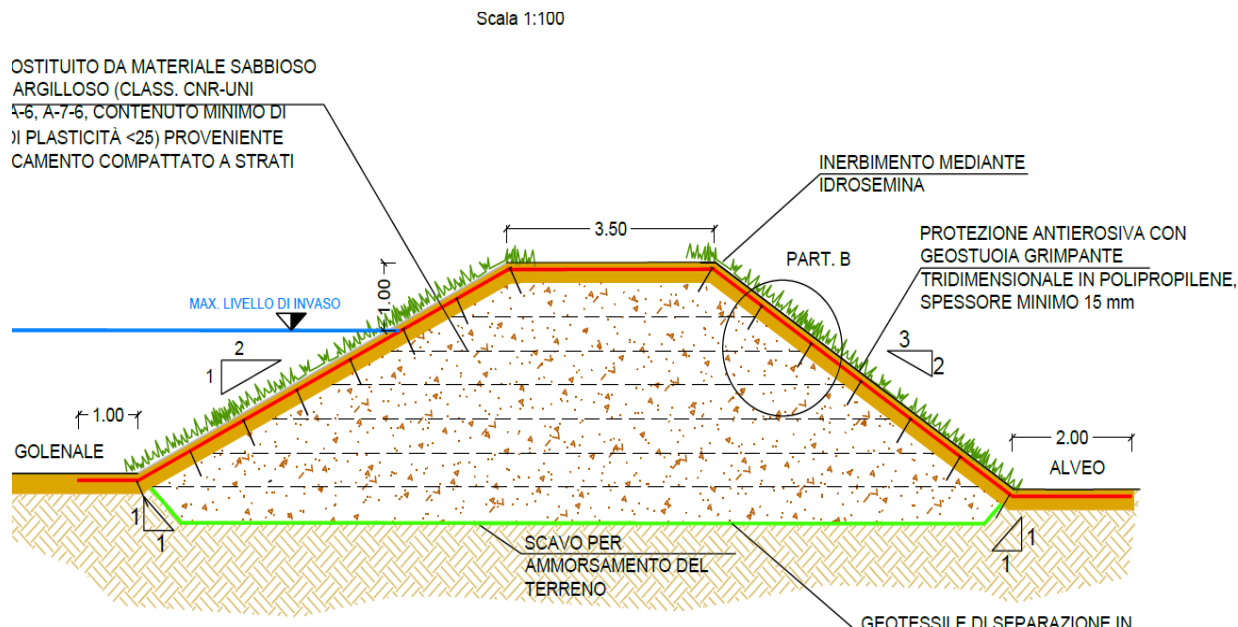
Area golenale 6 - sezione tipo di rilevato arginale con protezione antiersiva
